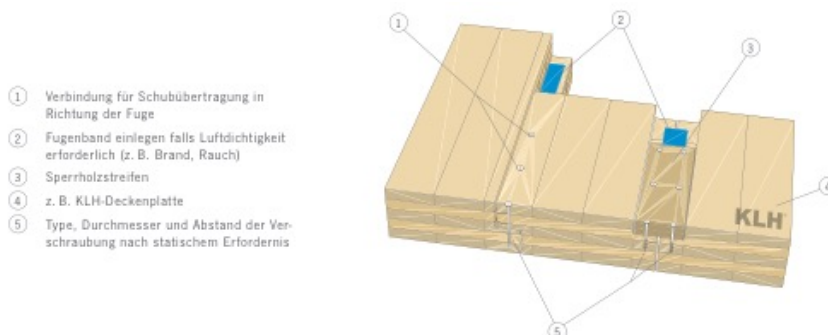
Stoßverschraubung am Beispiel eines Deckenelementes mit Stufenfalz und Stoßbrett (KLH Massivholz GmbH)
